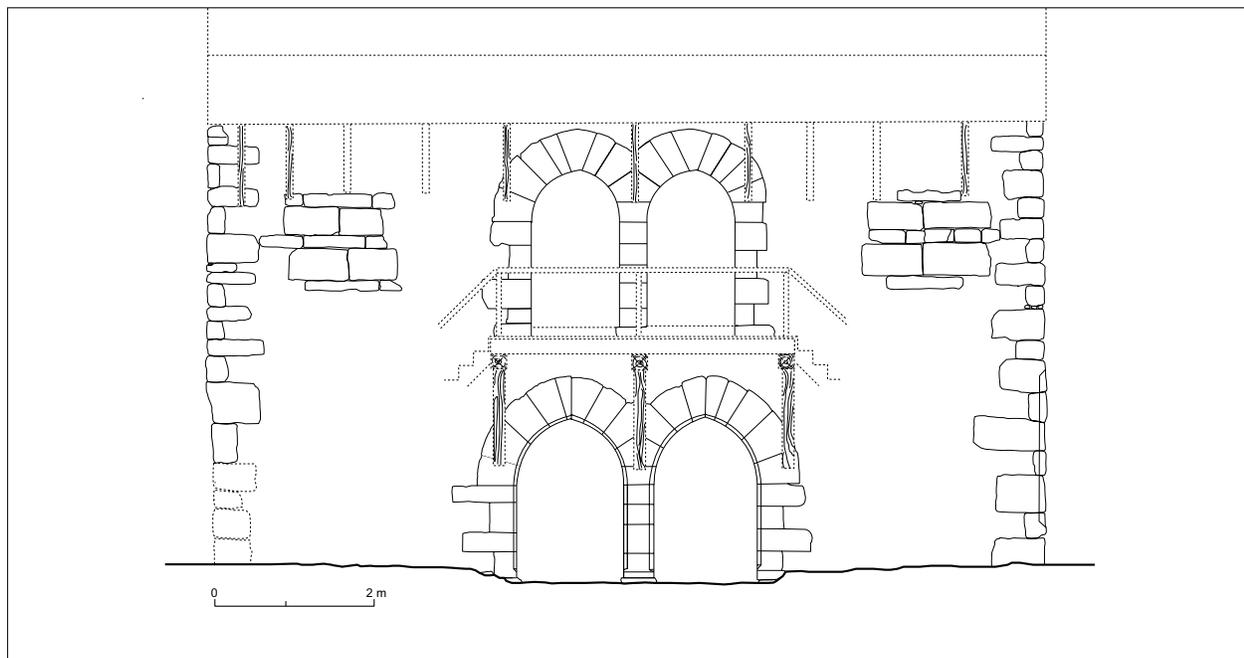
MAISONS JUMELLES N° 1. Proposition de restitution de la façade principale au XIIIe siècle. Dessin V. Rousset, 2001.
